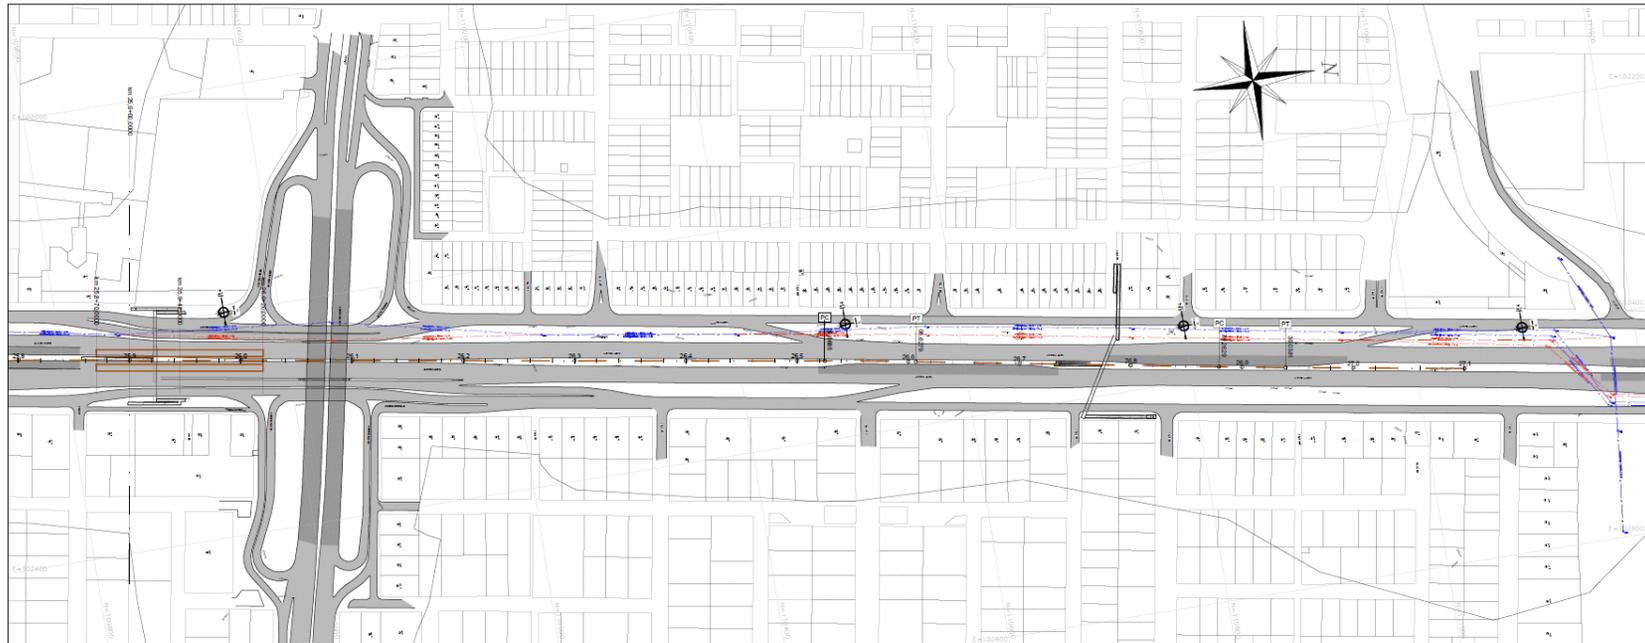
Vista en planta Alternativa 6, Tramo “nodo calle 92”-calle 100 Sur
